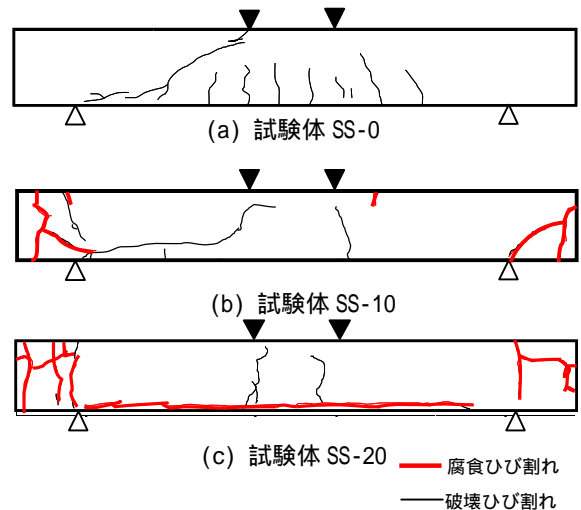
破壊ひび割れ性状(SSシリーズ)
